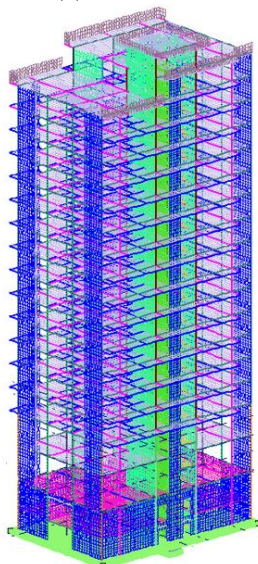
Расчетная схема 16-ти этажного железобетонного здания
